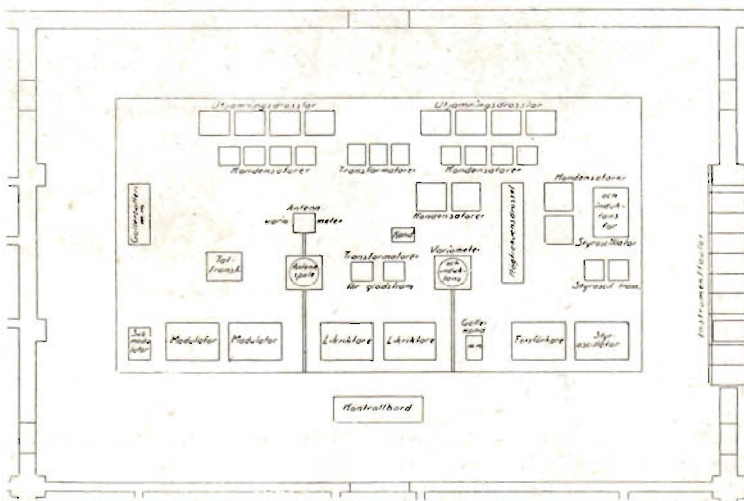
Plan av apparatsalen, i vilken sändaren inmonterats.
